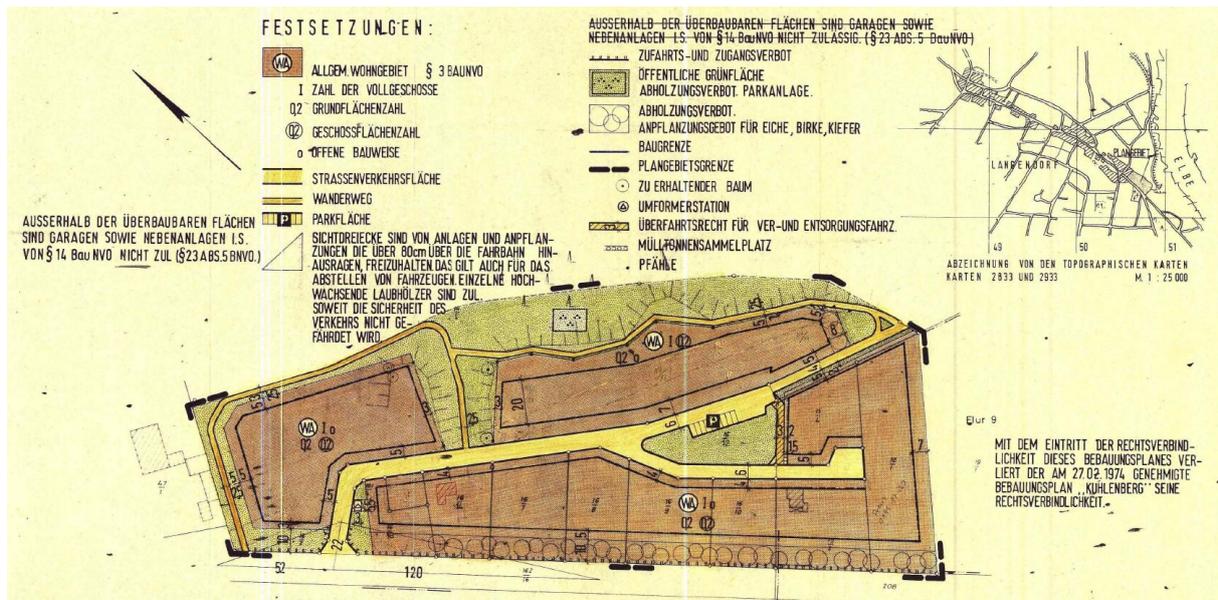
Bebauungsplan „Kuhlenberg Neufassung 77“
